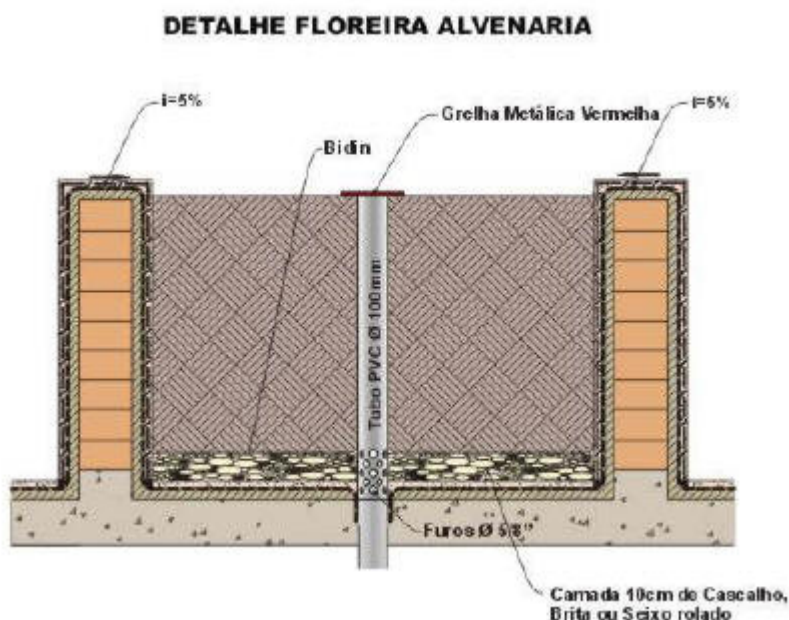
Impermeabilização de floreiras com paredes em alvenaria
